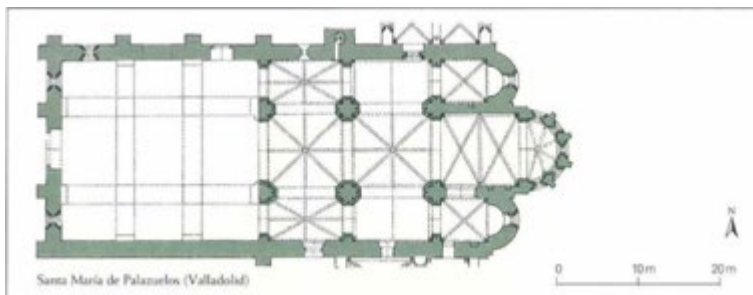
Palazuelos, Santa María, Grundriss Kirche, 13. Jhdt.
